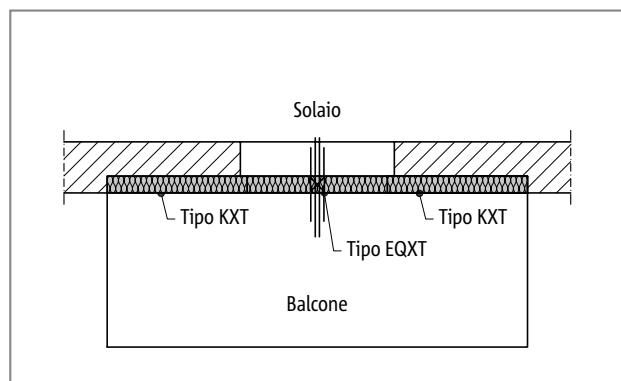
Schöck Isokorb® tipo EQXT: balcone a sbalzo con momento positivo
